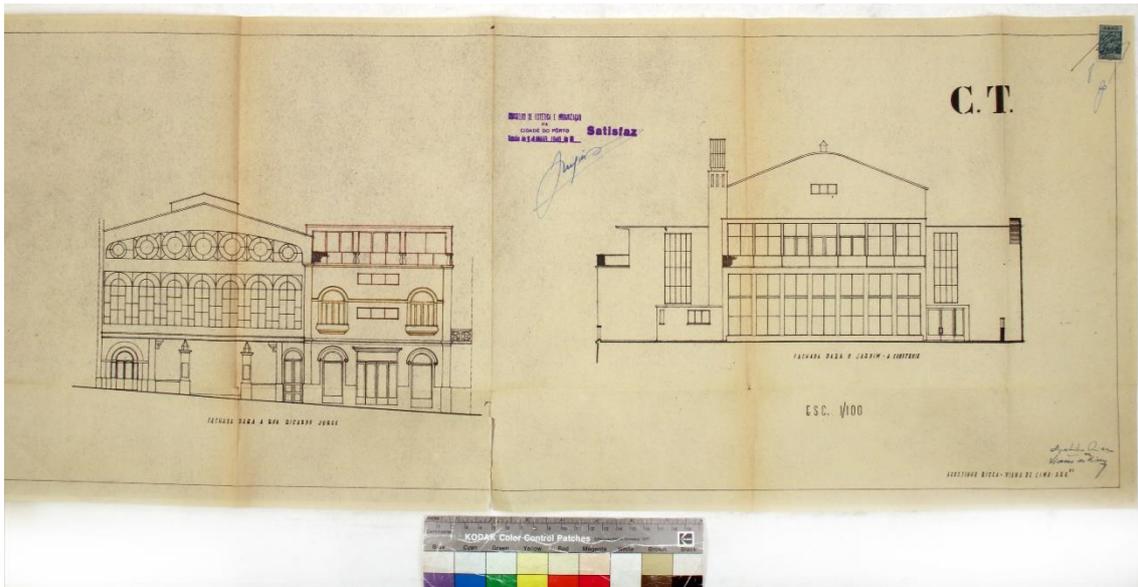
Fachada para Rua Dr. Ricardo Jorge; Fachada voltada ao Jardim a construir
